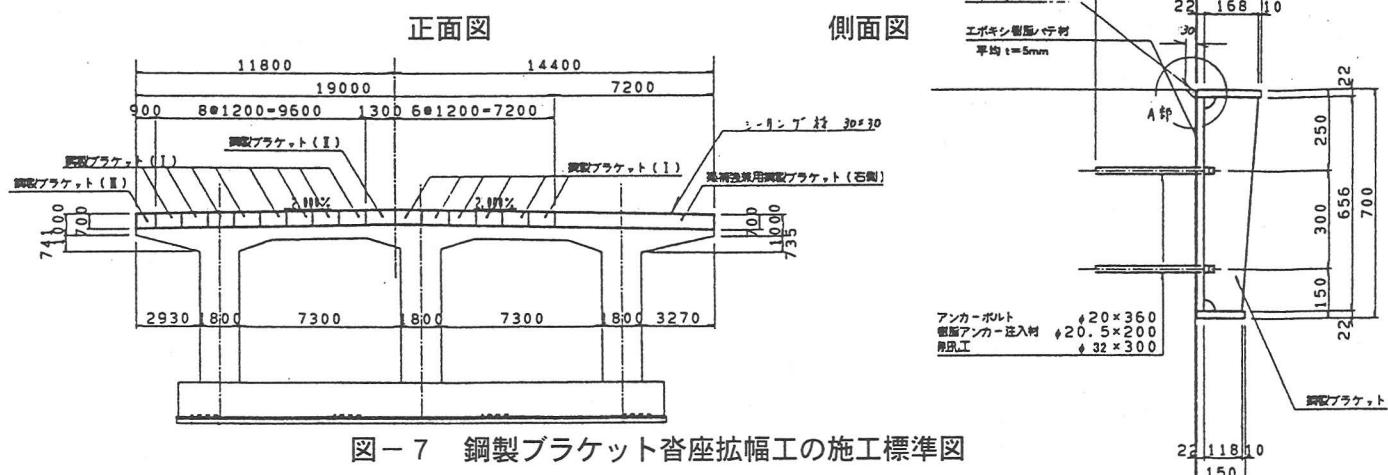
鋼製ブラケット沓座拡幅工の施工標準図
